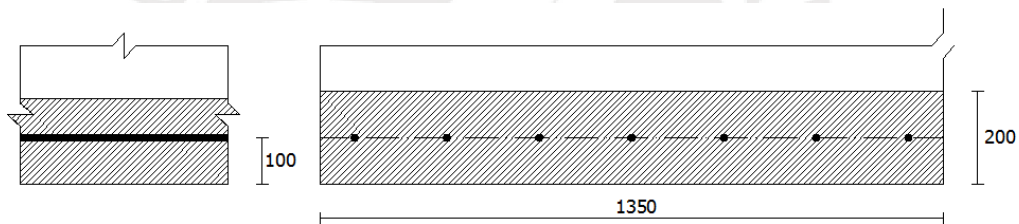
Núcleo de concreto para los tirantes.
